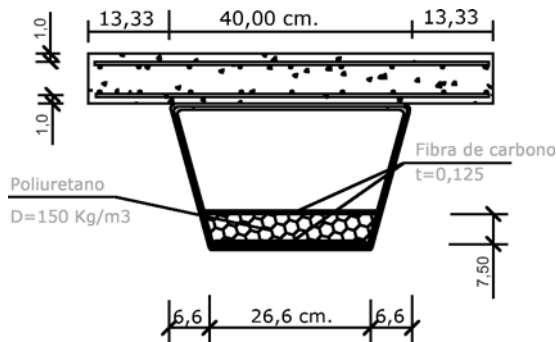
Detalle de rigidizadores horizontales en la sección de apoyo.
